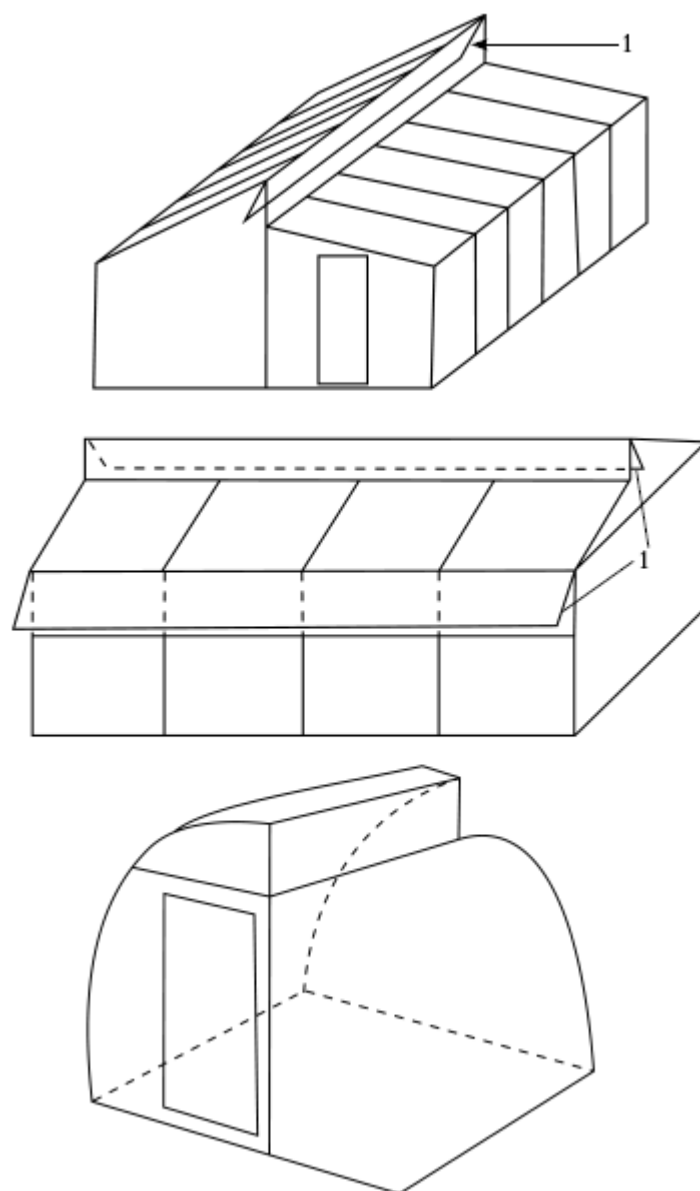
Теплица конструкции Дж. Митлайдера: а) с вертикальными стенами и одной фрамугой; б) с вертикальными стенами и двумя фрамугами; в) арочная; 1) вентиляционная фрамуга
